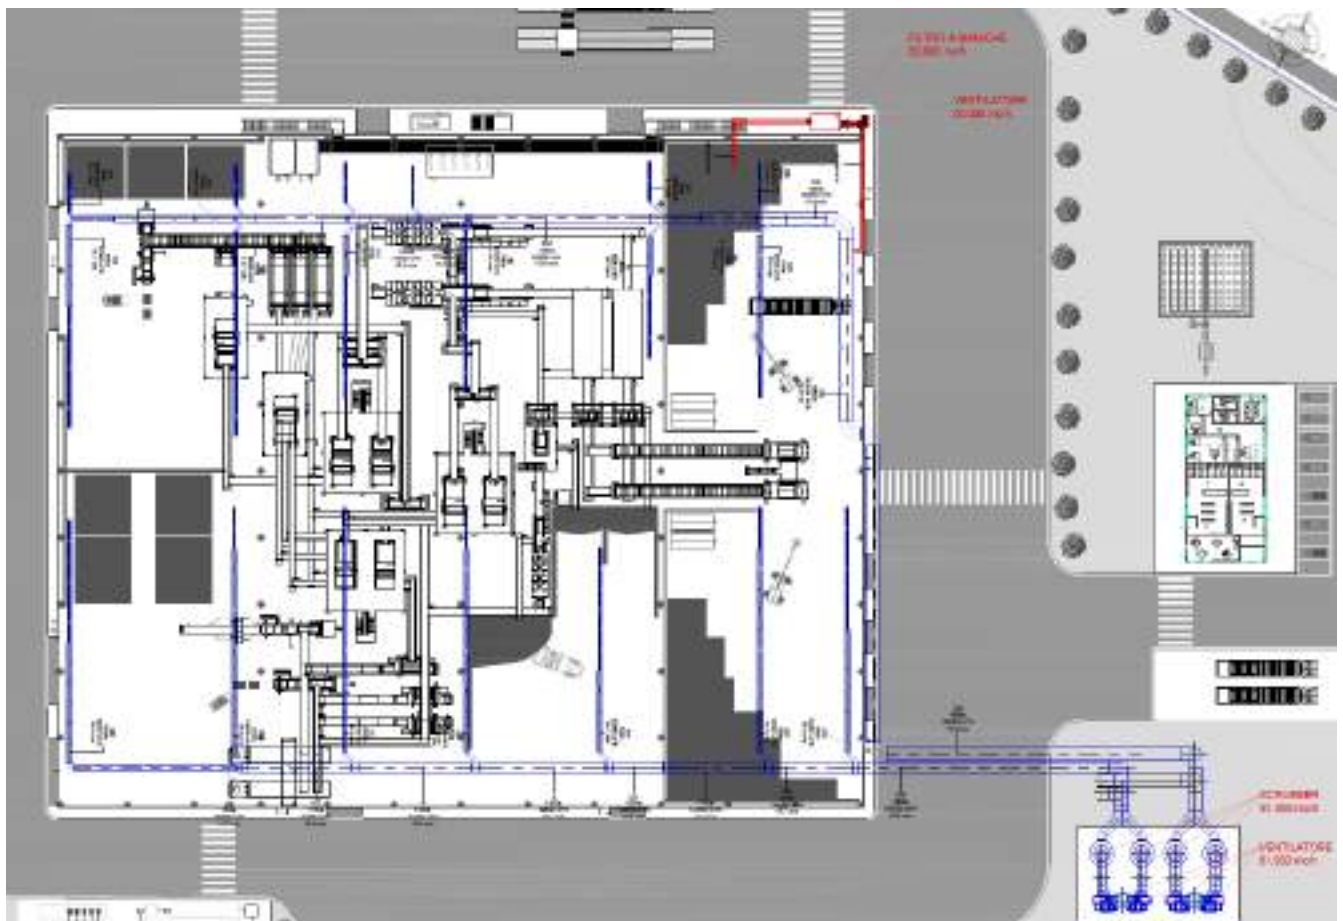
Stralcio tavola DE.EGR.VAR.019 - Planimetria aria
